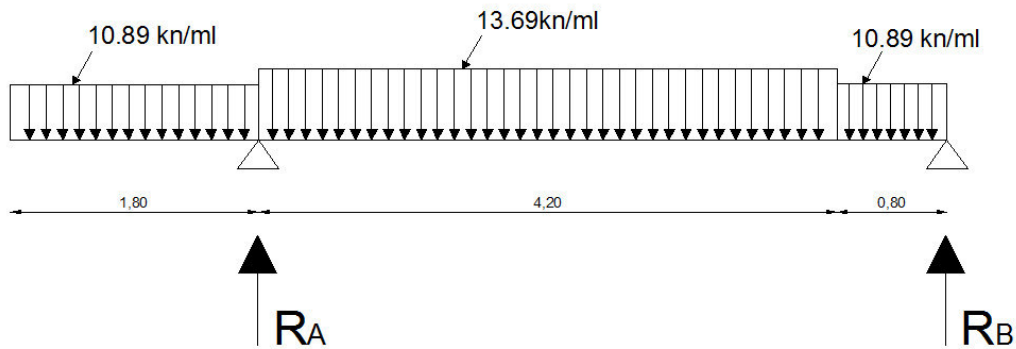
Schéma statique des escaliers à l'ELU.
